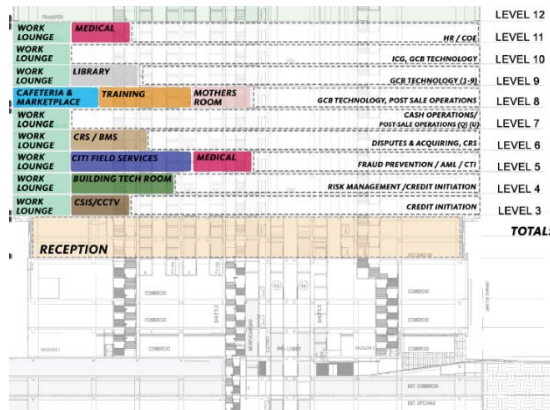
GENSLER, Corte esquemático, 2014, Plano.
